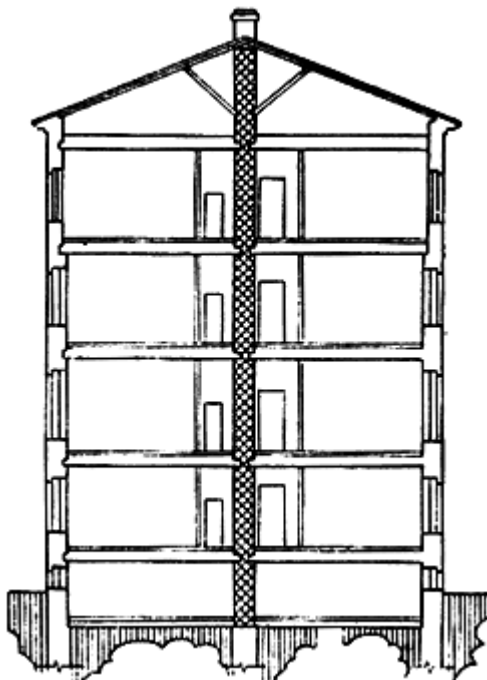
Проектное решение по перекладке участка средней продольной стены, показанного на рис. 1 б с сохранением существующих перекрытий
